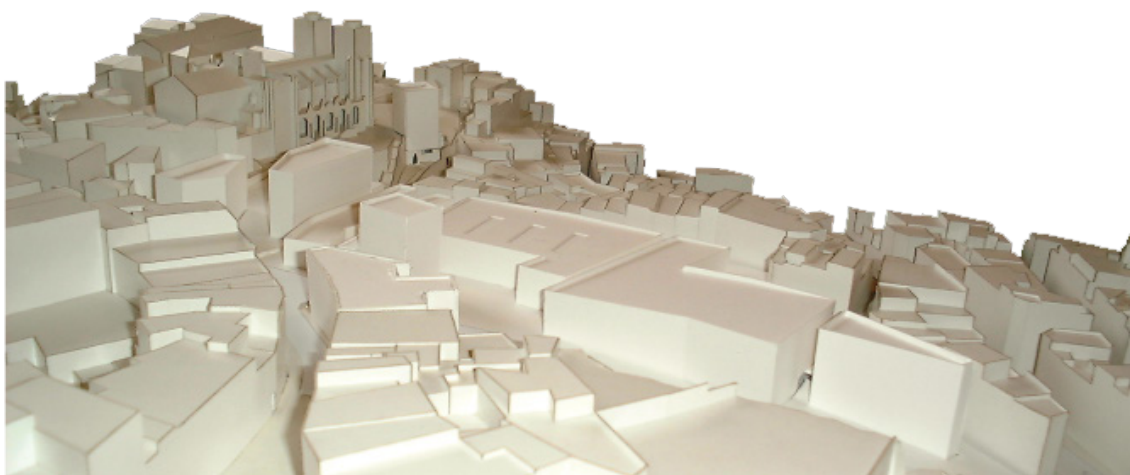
Maqueta Projecto para Avenida da Ponte, 2000
